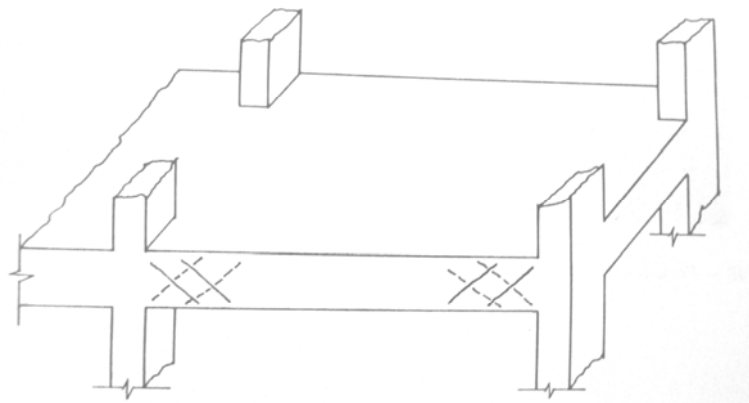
Fissuras provocadas por torção. (Fonte: THOMAZ)
